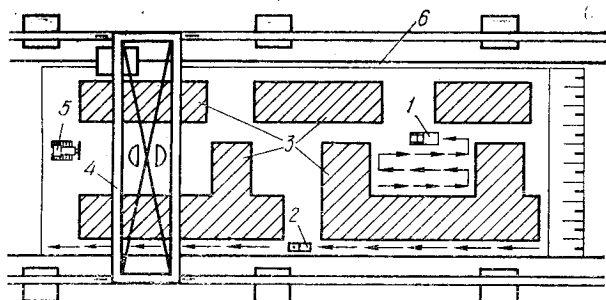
Схема обратной засыпки и уплотнения грунта между фундаментами внутри цеха:
